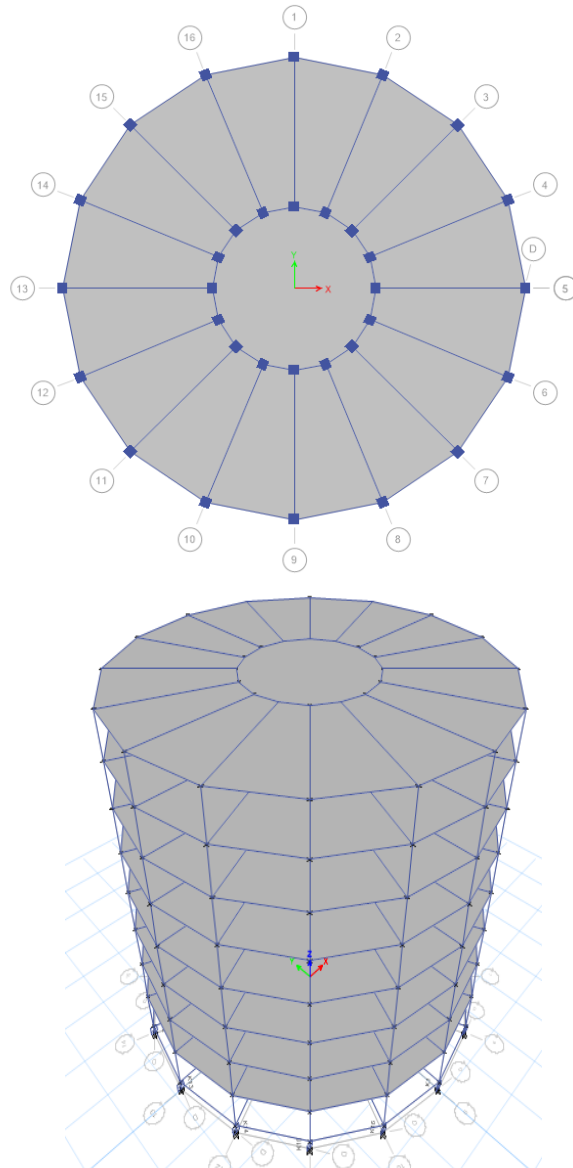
Vista en planta y en 3D del modelo estructural circular.
